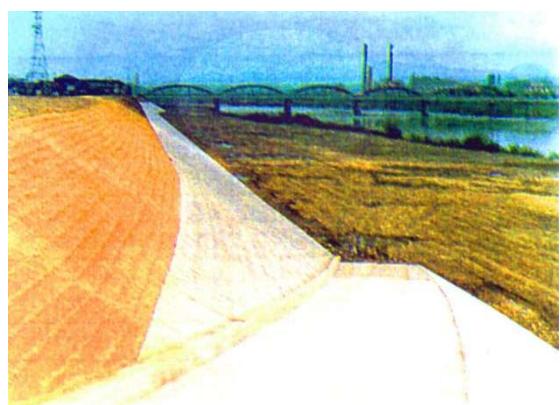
高津地区護岸の施工状況（昭和54年）
